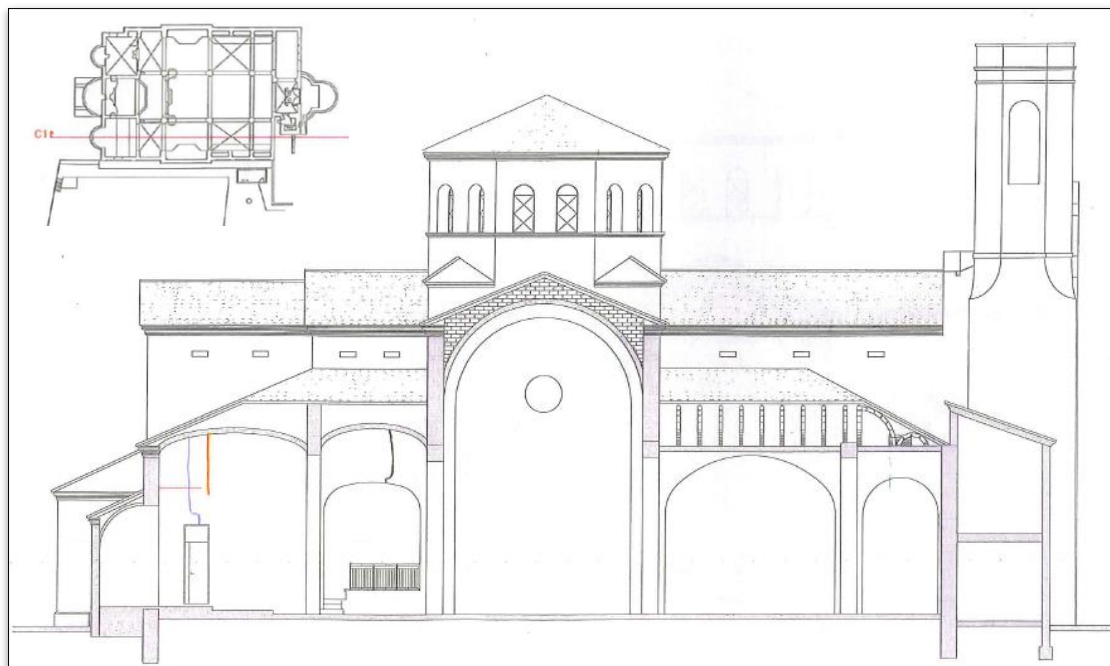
Grietas sección longitudinal ala oeste (plano PAT. 06)
